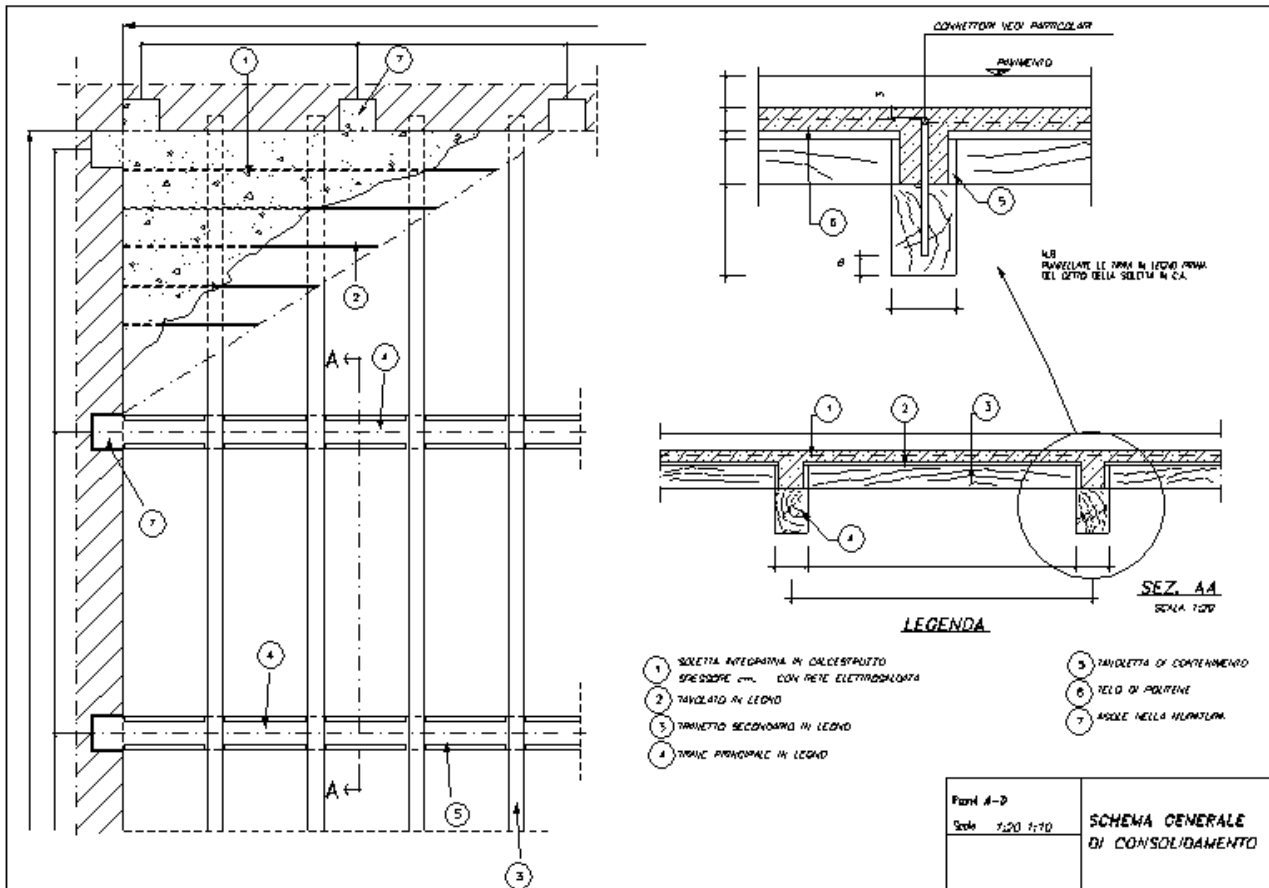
Pianta solaio piano secondo corpo N-E "Ex-Cucine": schema generale di consolidamento
